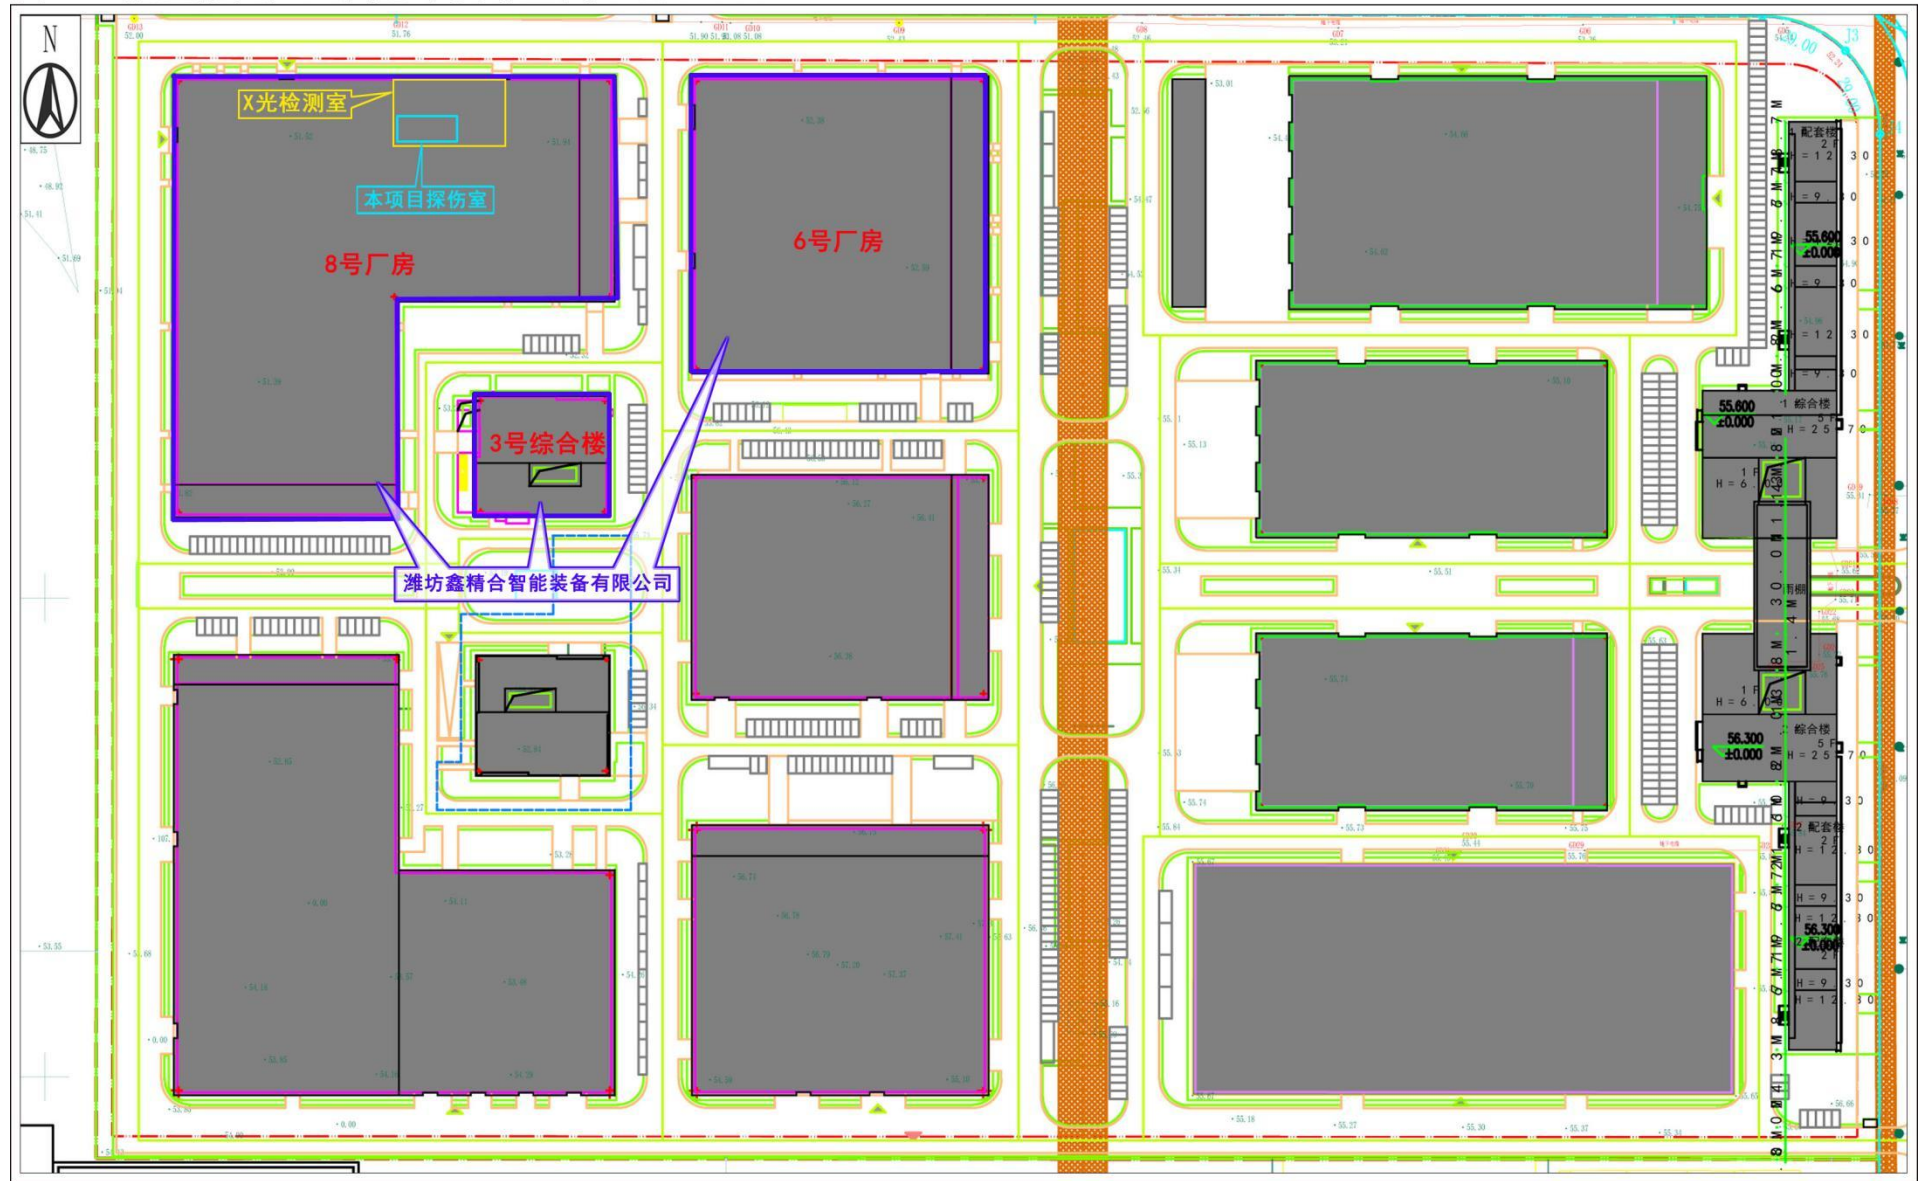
本项目所在8号厂房平面布置图 比例尺1:900
